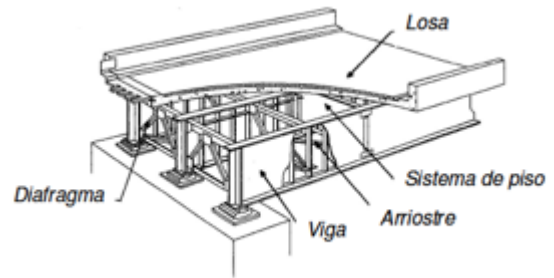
Elementos de superestructura. Viga Tipo I (Manual de inspección del MOPT)
